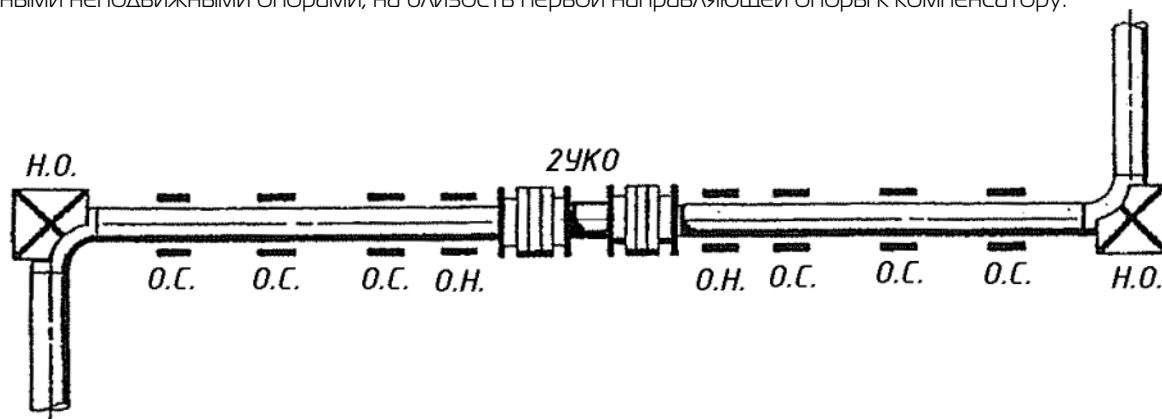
Схема установки двойного компенсатора осевого (2УКО)
